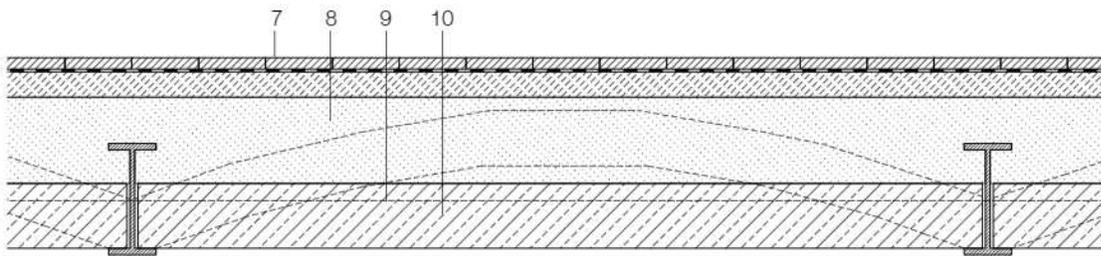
Austausch einer Kappendecke gegen eine Stahlbetondecke
